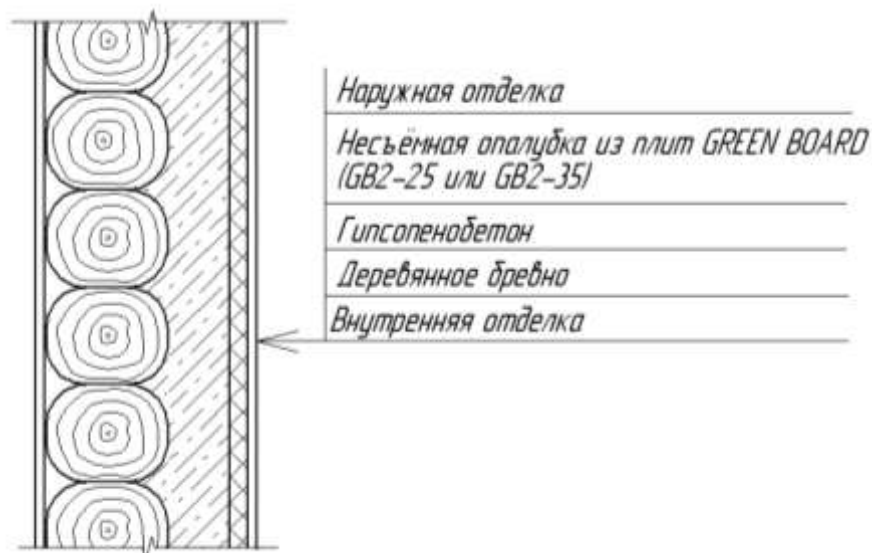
Разрез деревянной стены, с залитым гипсопенобетоном, с наружным покрытием без швов, поверх несъемной опалубки
